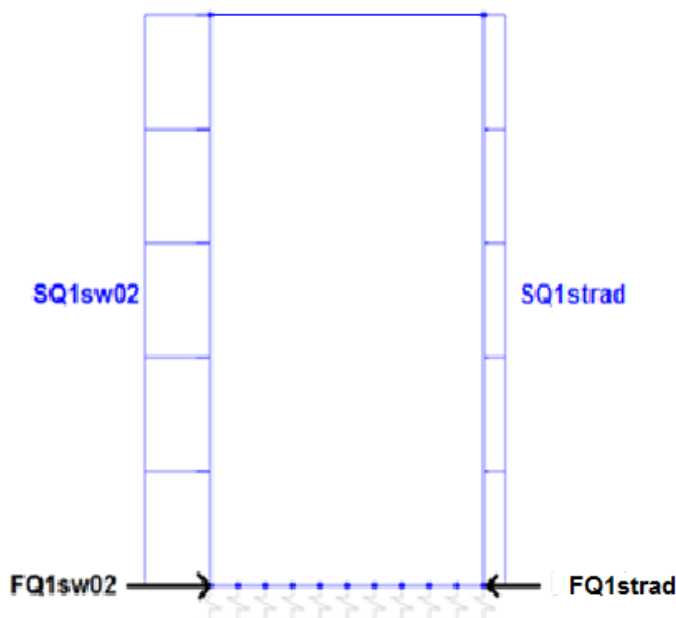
Condizione di carico SPACCSXSW/02 e SPACCDXSTRAD da SAP2000
